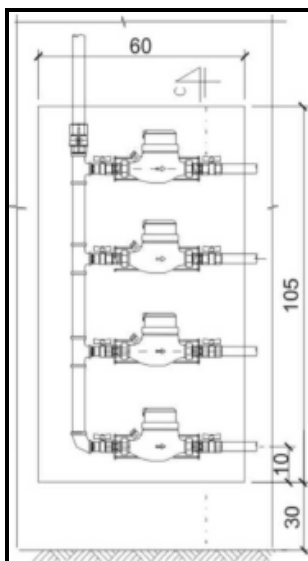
Grupo de medidores nos pavimentos – Adaptada da Cartilha da COPASA sobre medição individualizada.
